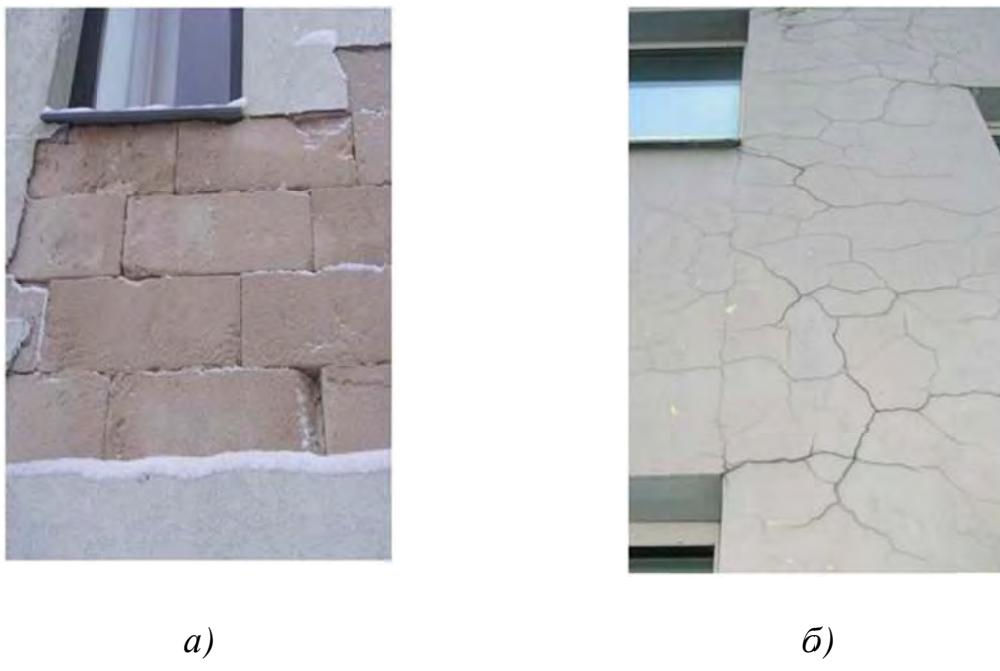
Нарушение сцепления с газобетоном и отслоение отделочных слоев от кладки: а – отрыв штукатурки с высоким сопротивлением влагообмену от влажной кладки; б – трещина на штукатурке, затворенной избытком воды
